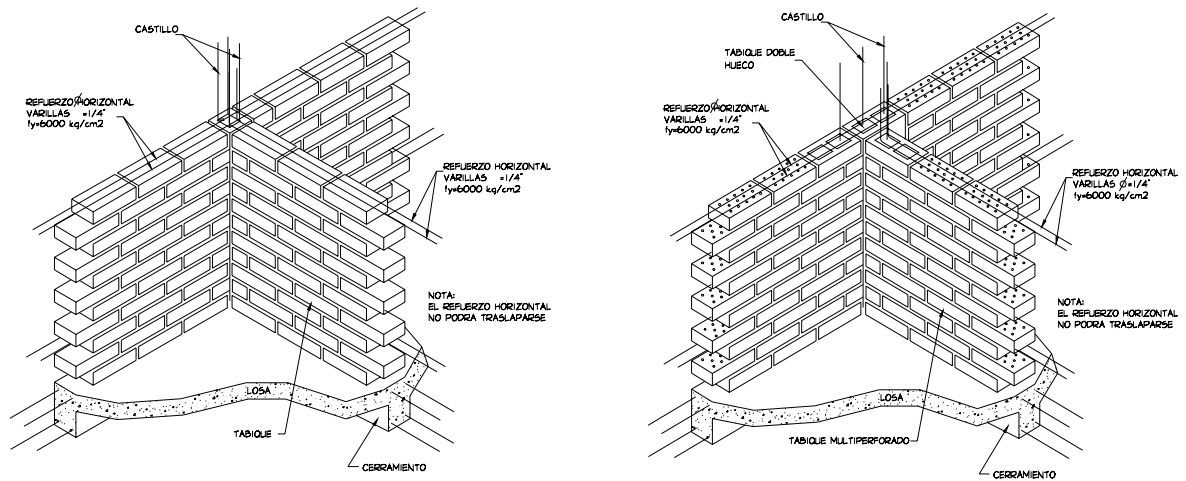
Mampostería confinada, con refuerzo horizontal
